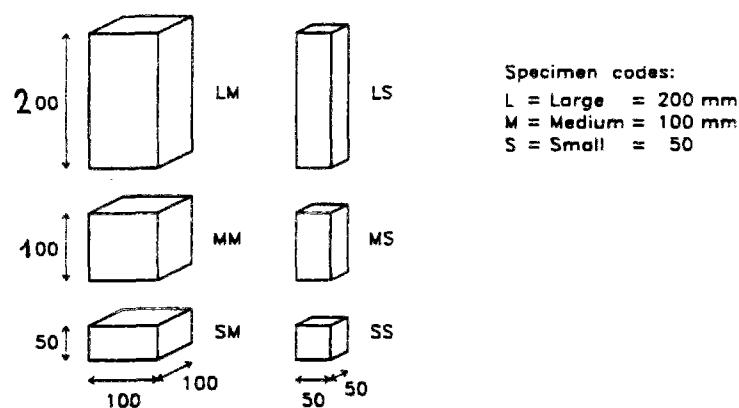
Géométries des éprouvettes prismatiques.
